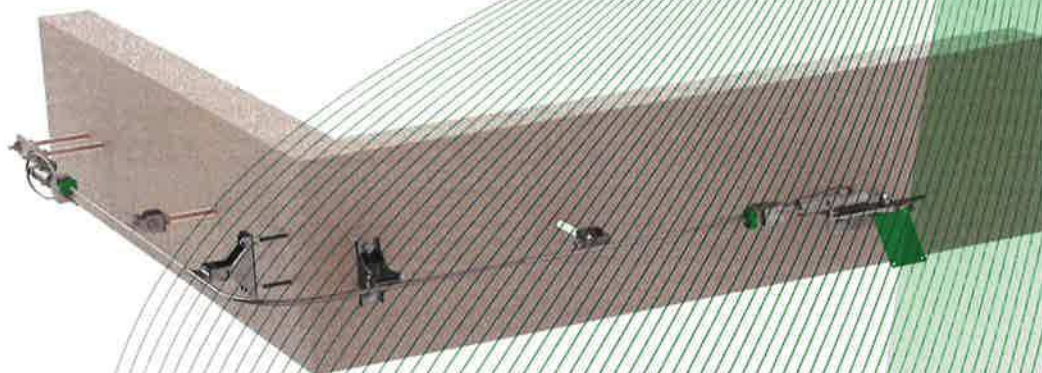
Anschlagereinrichtung Typ C, Typ: Greenline GES-3, Montagebeispiel Fassade Drahtseilsystem mit Kurven überfahrbar
